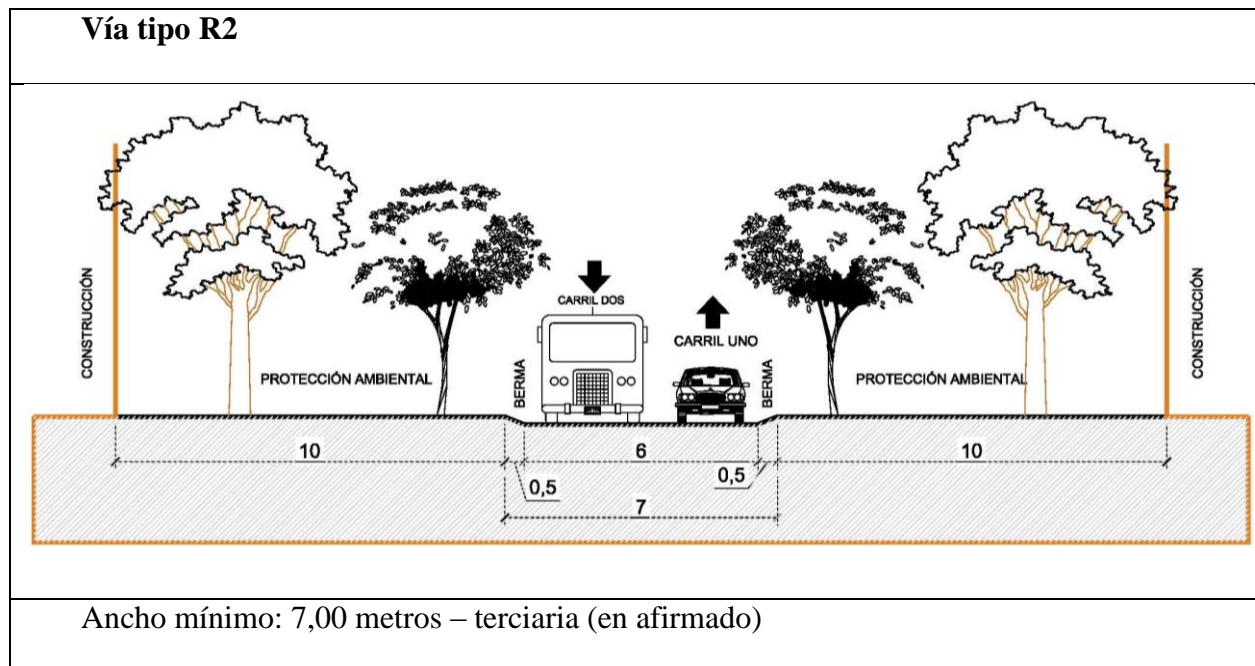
Perfil vial tipo R2. Fuente: POT Barrancabermeja.
